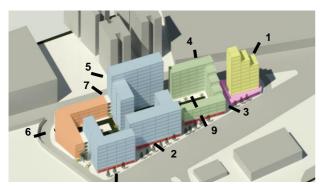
Quinta propuesta. Volumen, vista 1. Elaboración conjunta, Álvarez, González, Hurtado. 2022
